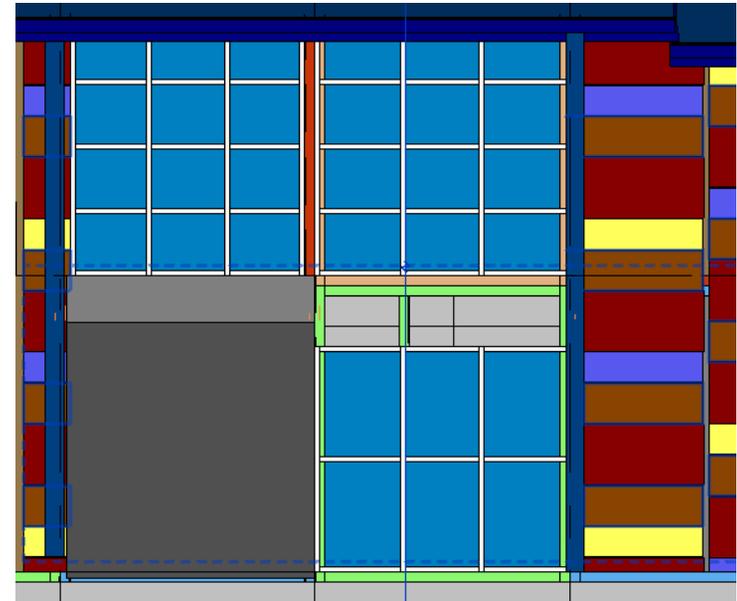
Detalle de variante de la elevación este, modificando las aletas.
